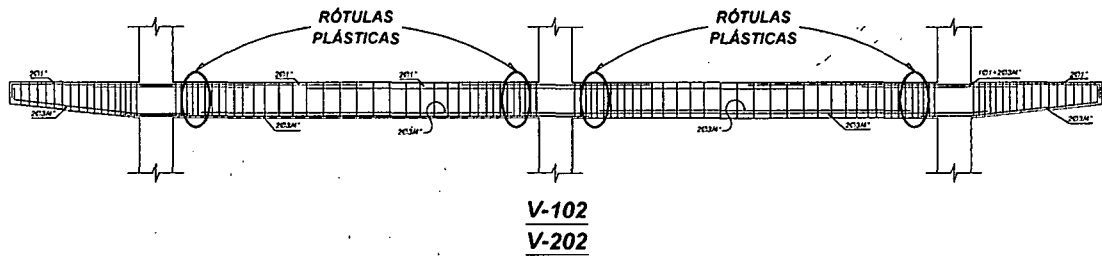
Ubicación de las rótulas a analizar en las vigas V-102 y V-202
